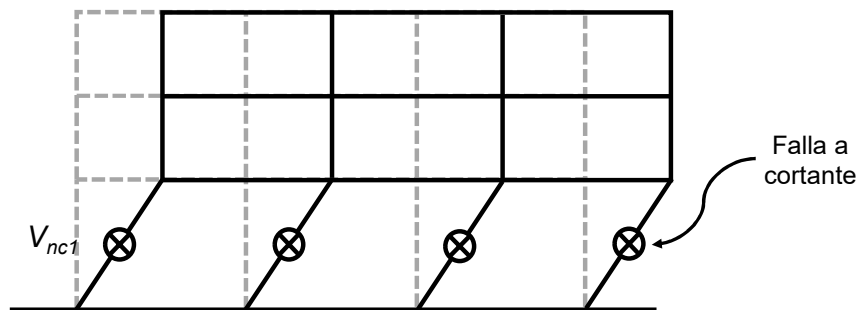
Mecanismo de colapso por planta baja débil asociado (FEMA P-2018).
